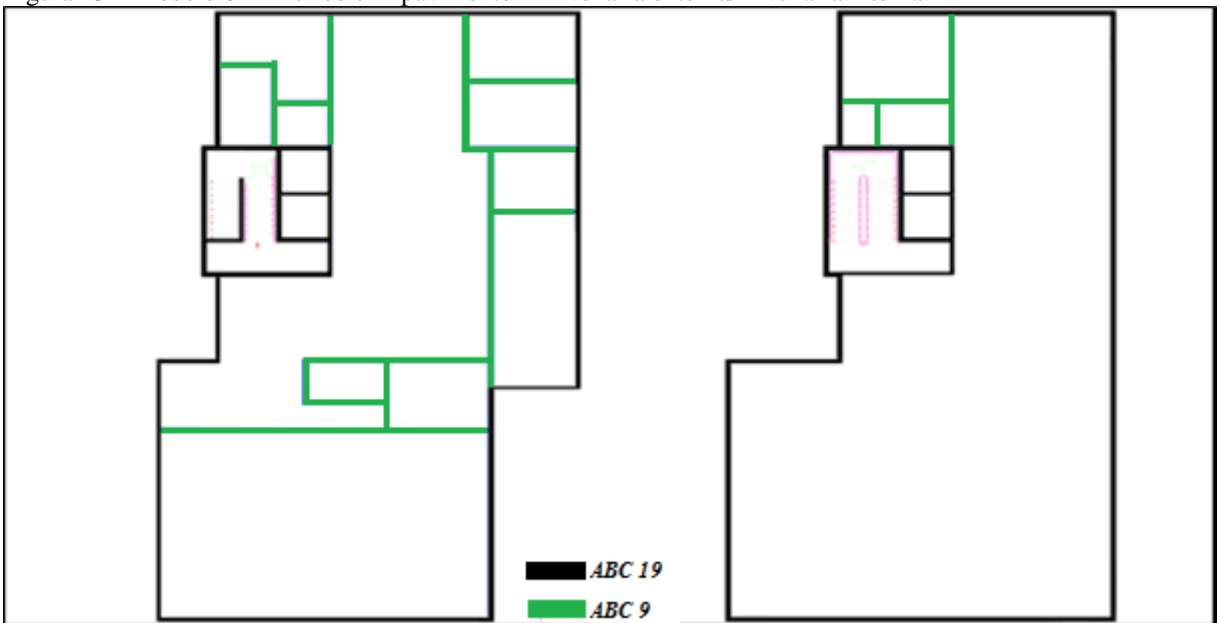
Layout arquitetônico do Térreo (esquerda) e 1º pavimento (direita)
